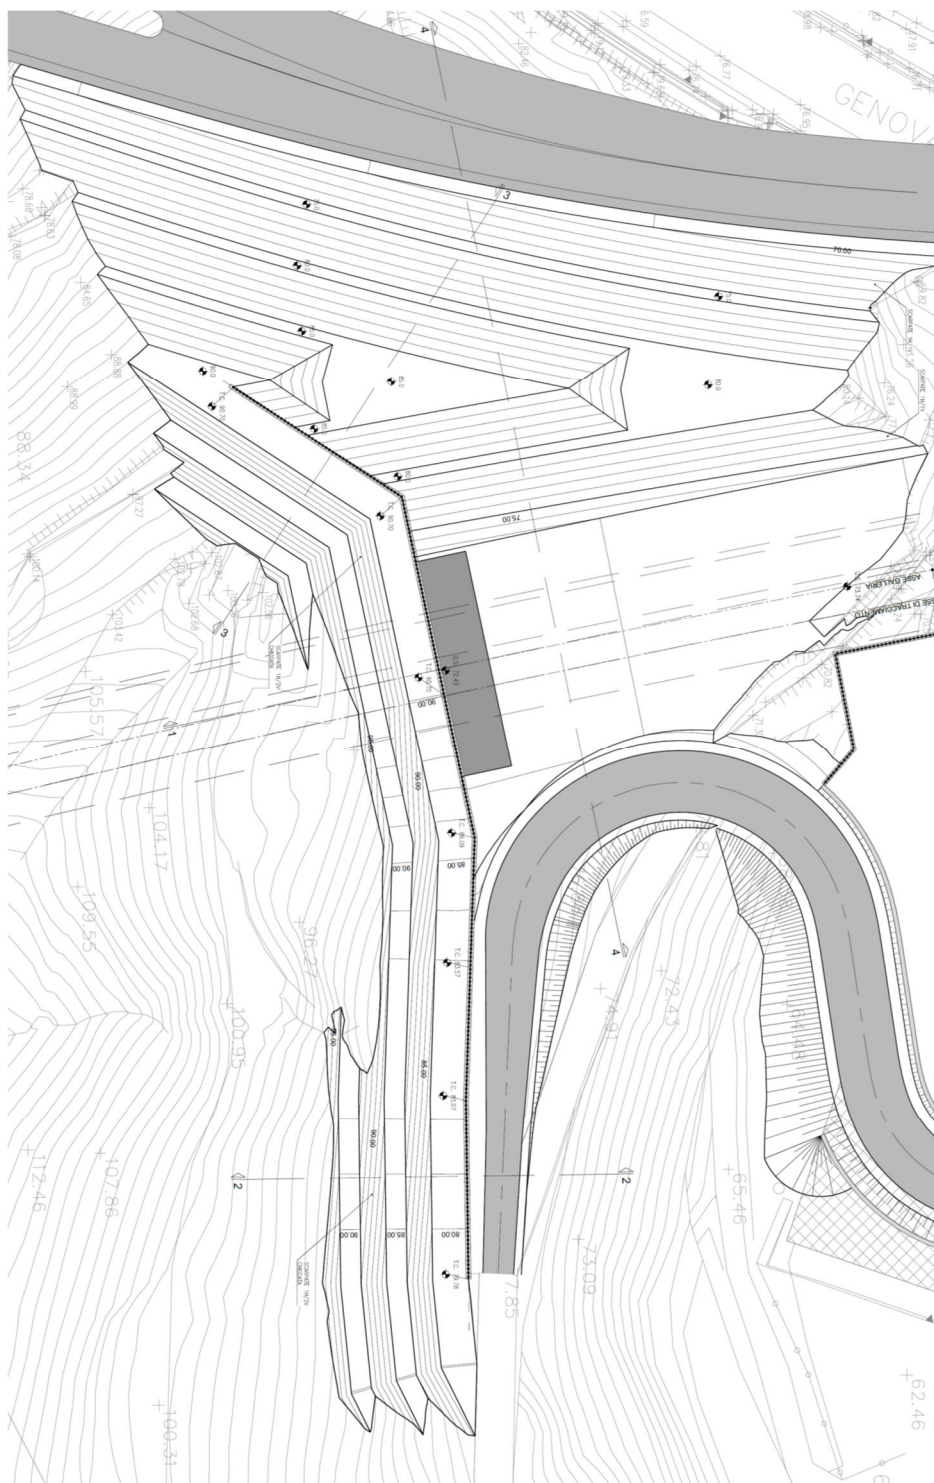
Imbocco Forte Diamante - Paratia di imbocco: Planimetria
